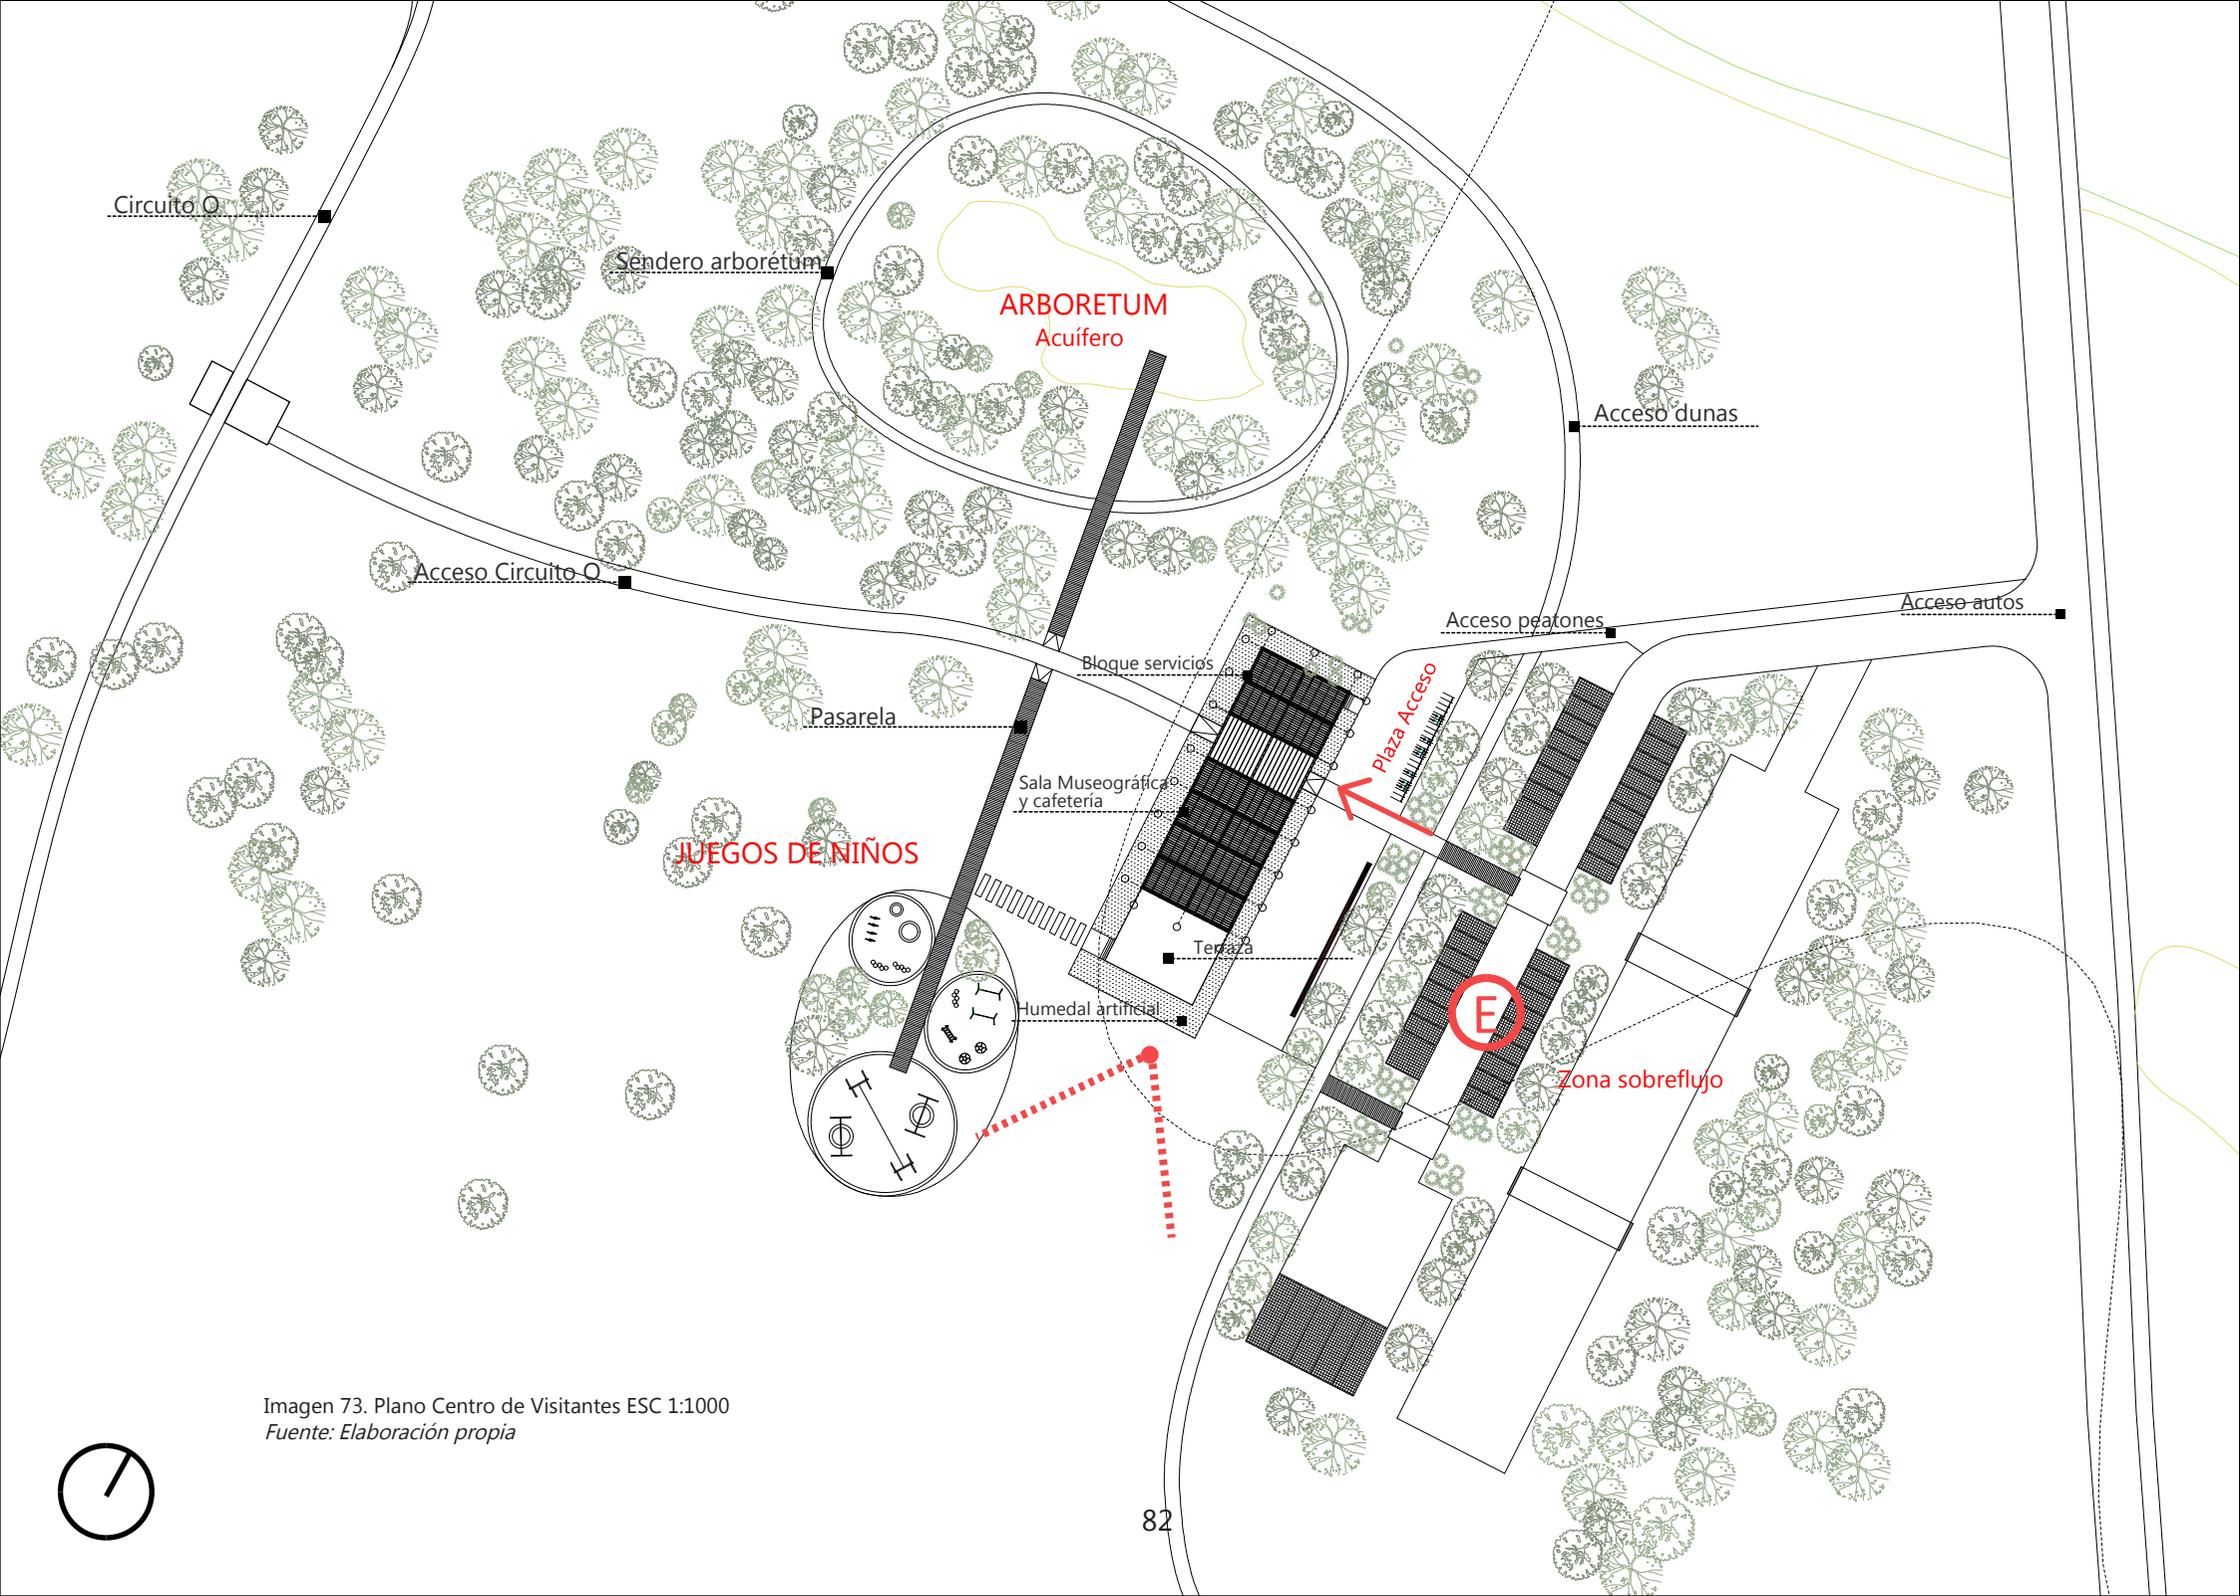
Plano Centro de Visitantes ESC 1:1000
